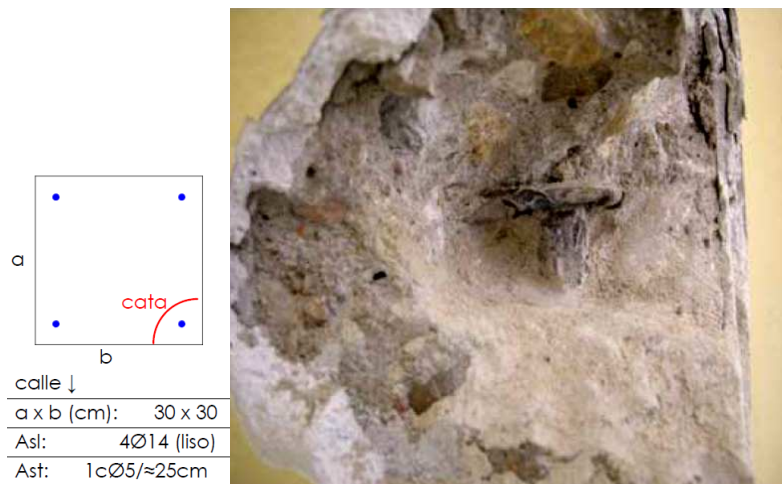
Cala en pilar Edificio 94C.023, 1968.
